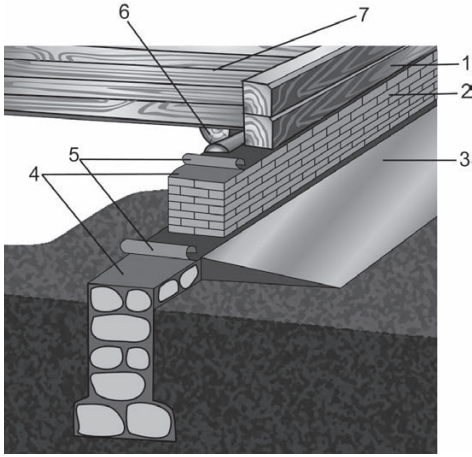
Схема монолитного ленточного фундамента: 1 — стена; 2 — цоколь; 3 — отмостка; 4 — раствор цемента; 5 — гидроизоляционный материал; 6 — лага; 7 — пол
